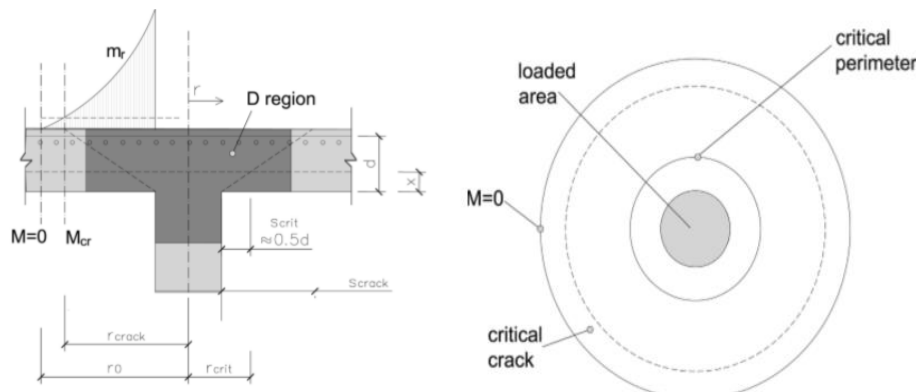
Fisura crítica, perímetro crítico y fuerzas en una porción de losa sobre la fisura crítica (Marí, *et al.*, 2018)
